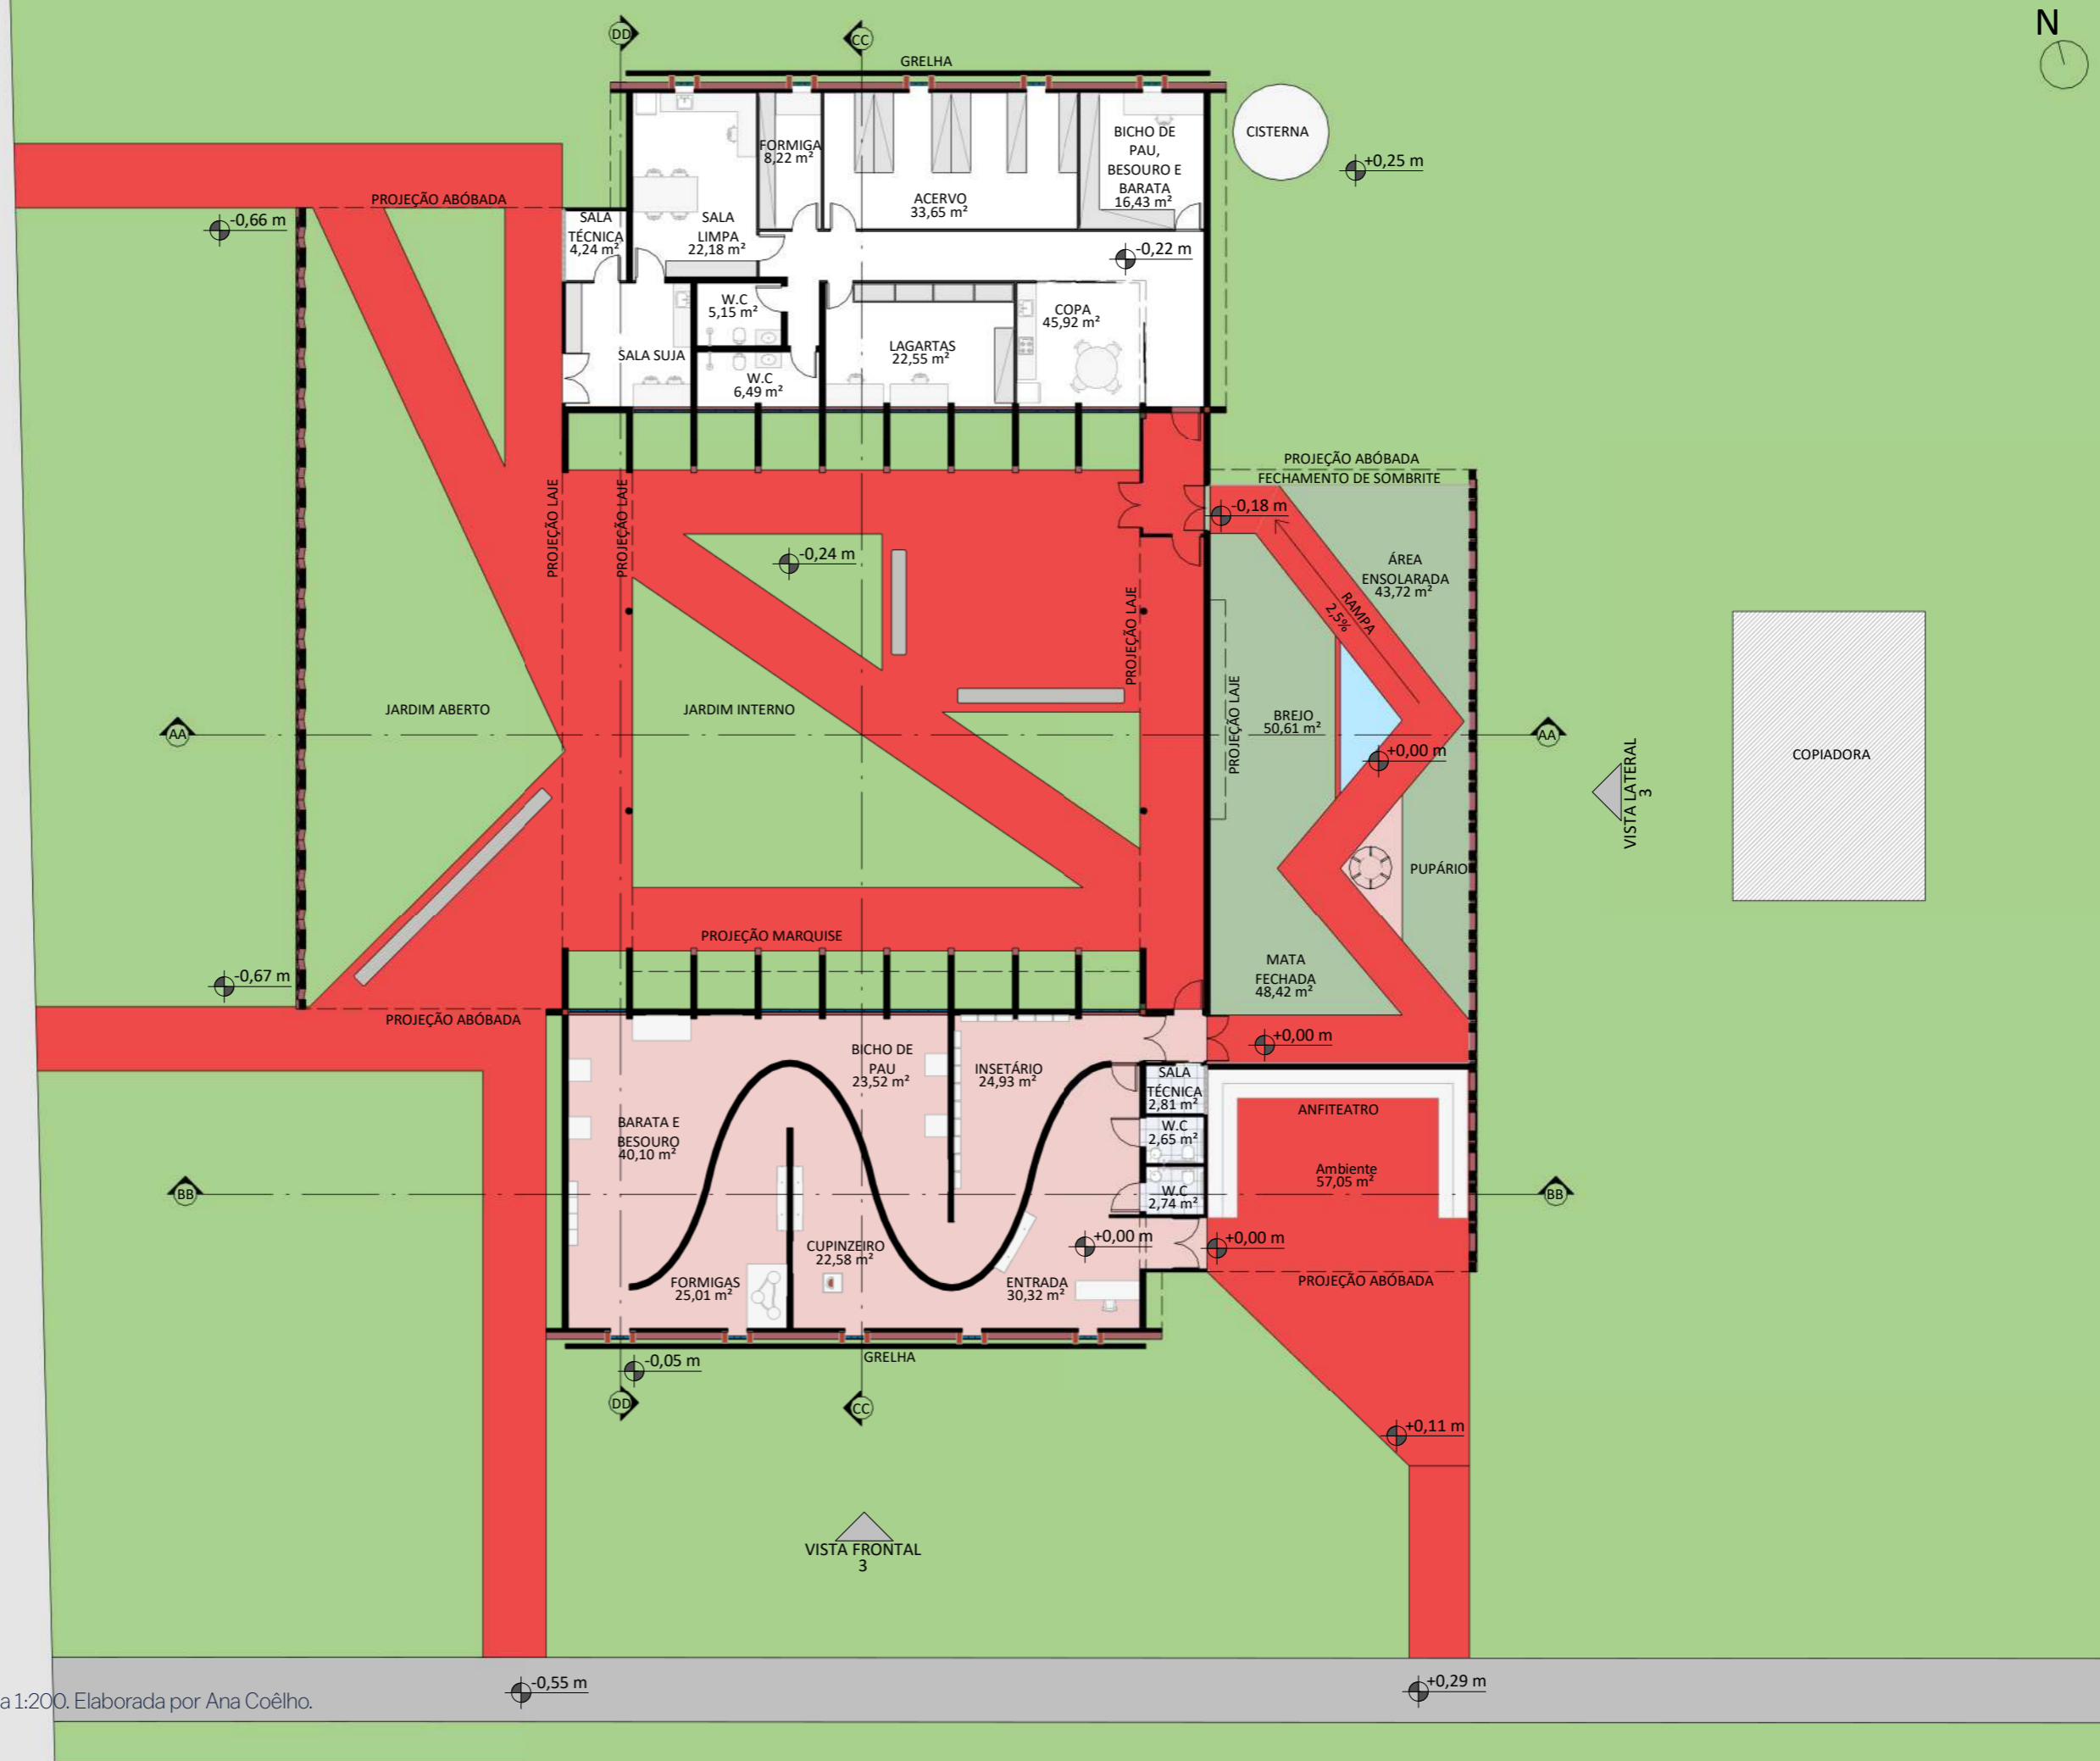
Planta térreo e implantação na escala 1:200. Elaborada por Ana Coêlho.
